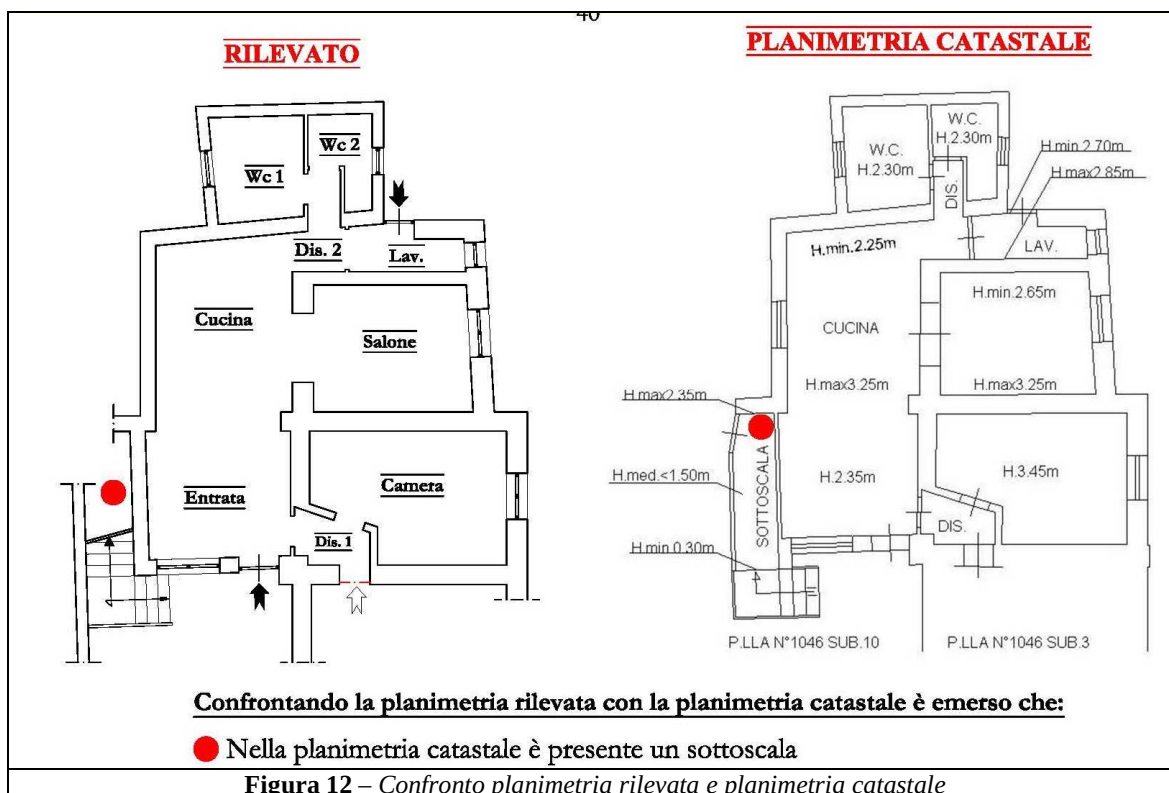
Confronto planimetria rilevata e planimetria catastale
